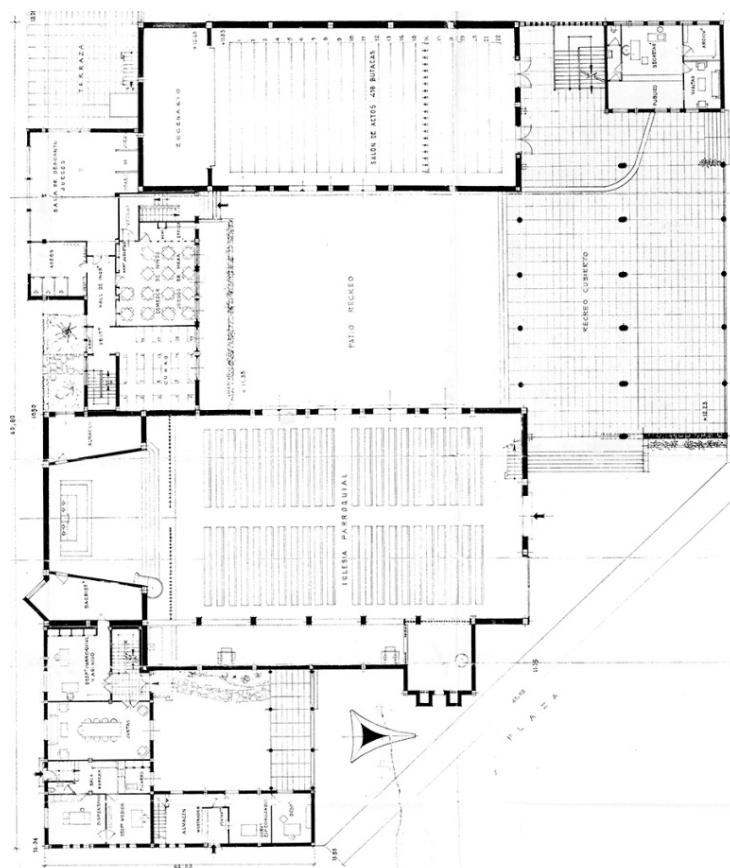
Plano del Conjunto Parroquial de Nuestra Señora del Pilar
